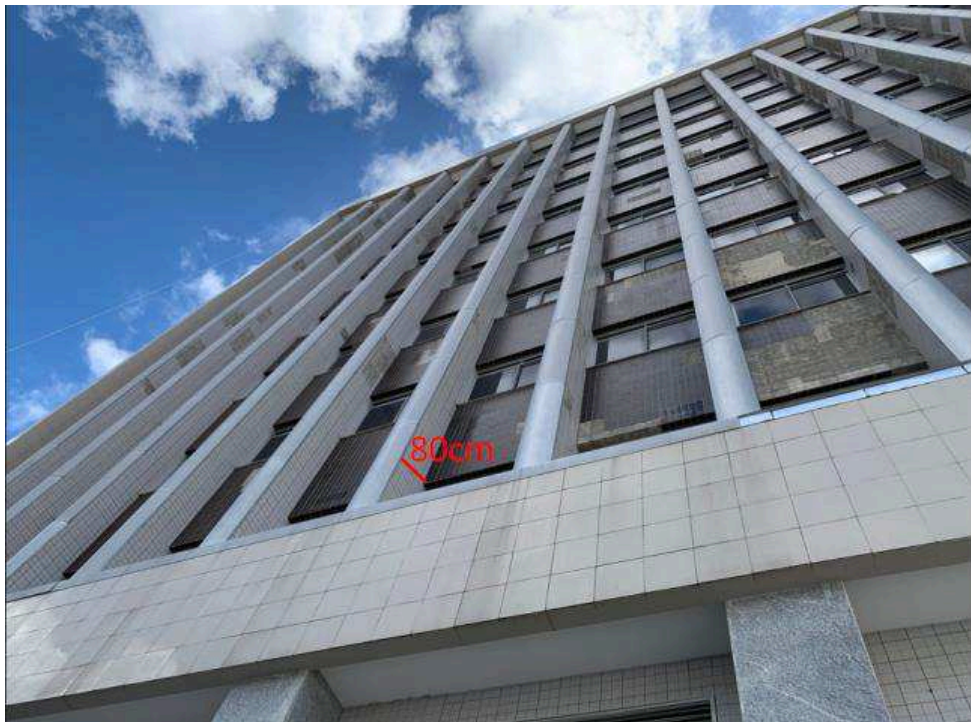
Detalhe do recuo da fachada Norte na dimensão de 80cm para acesso aos painéis abaixo das janelas dos pavimentos.
